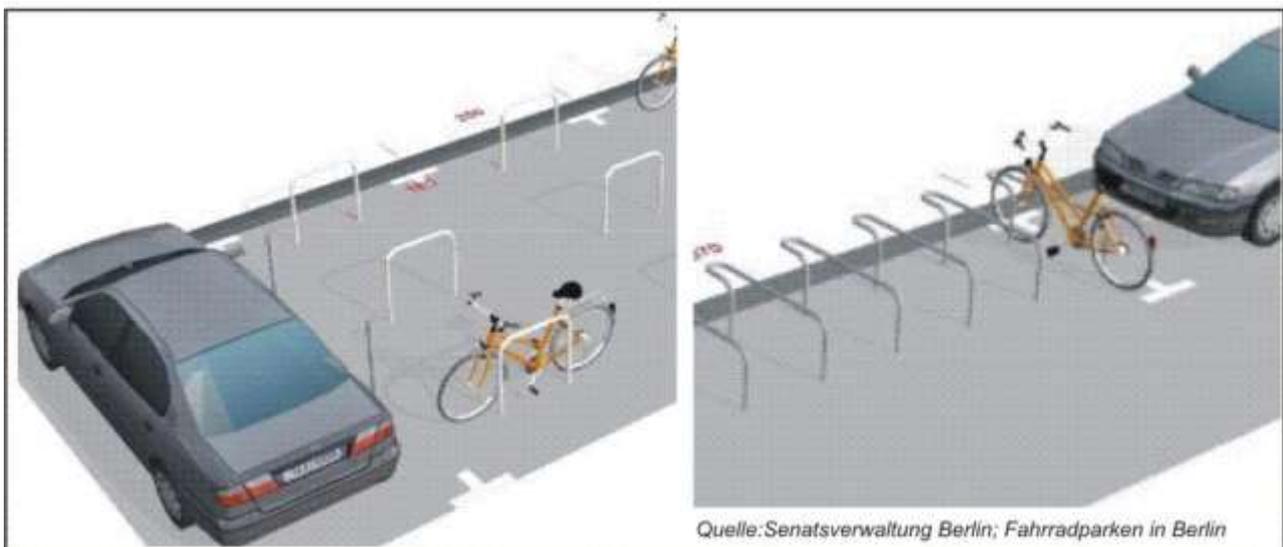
In Kfz-Parkierungsanlagen integriertes Fahrradparken
